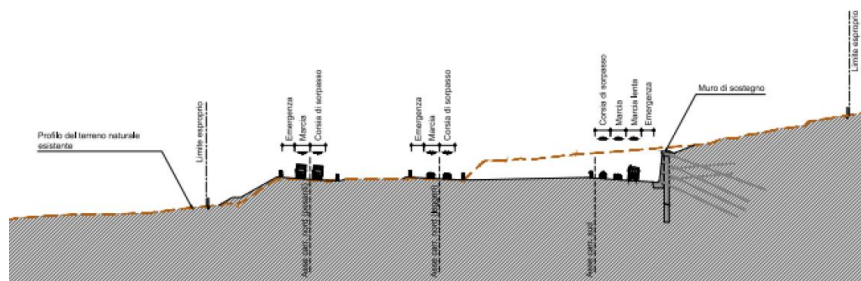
Sezione di progetto autorizzato (pk 10+200)
